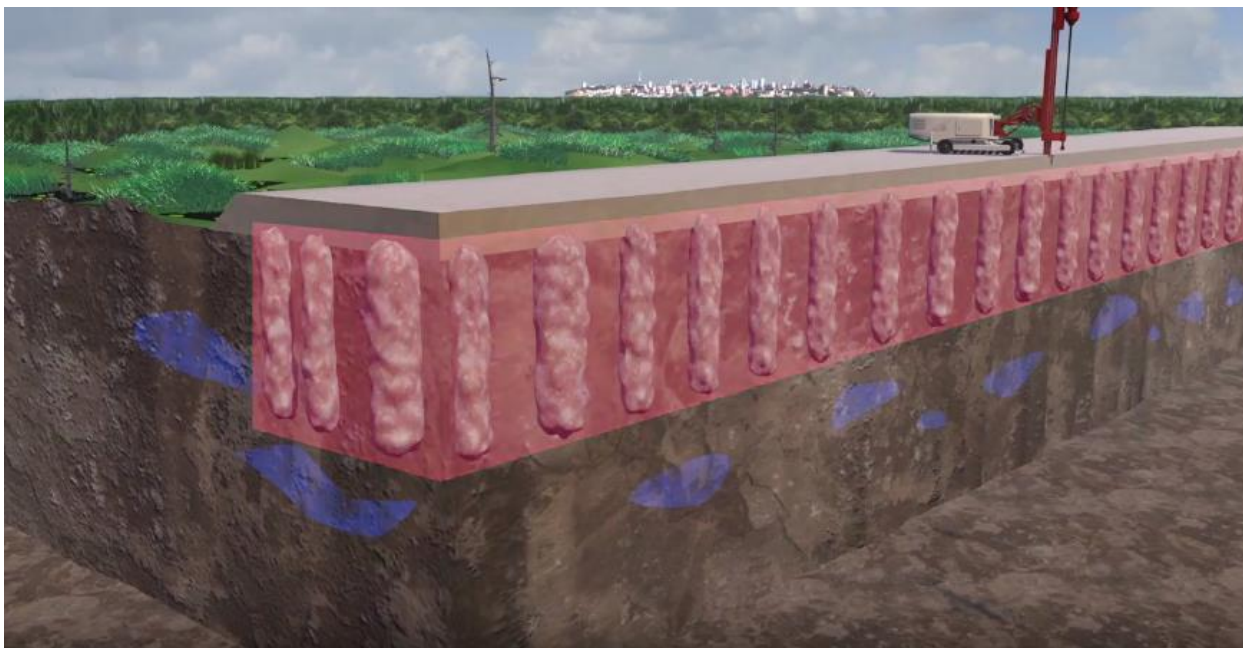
Модель армирования грунта в основании дорожной насыпи [117].
